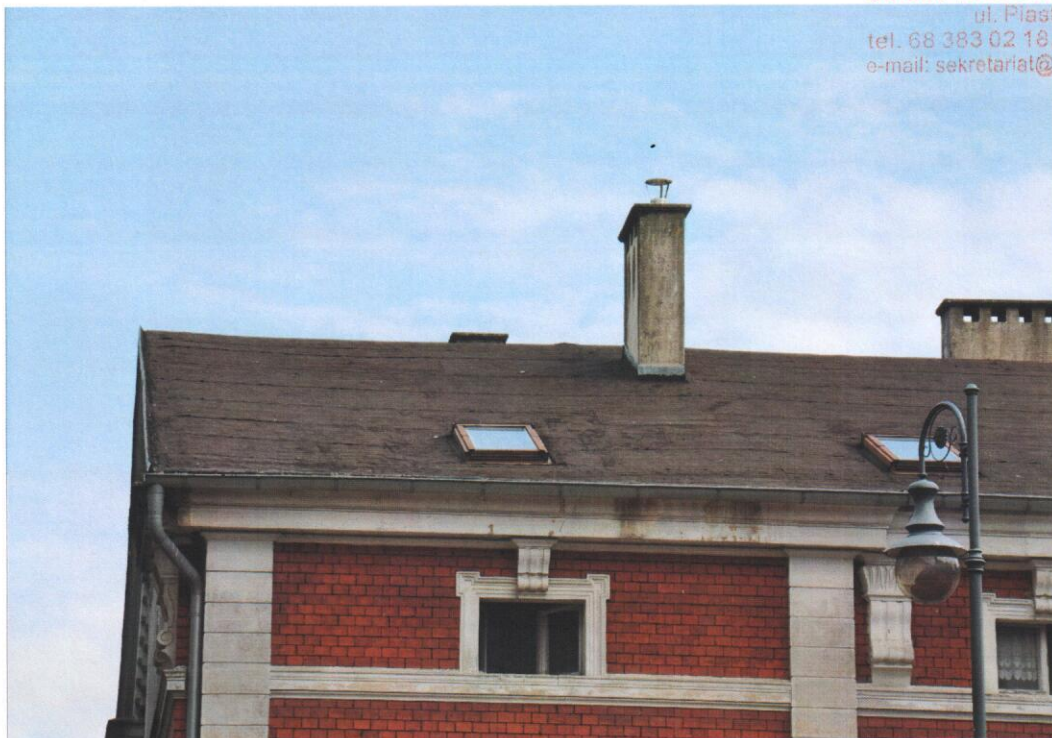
Dach i kominy (elewacja wschodnia).
